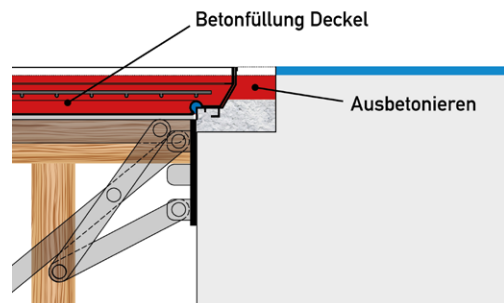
Aussparung und Deckelwanne mit Beton füllen
